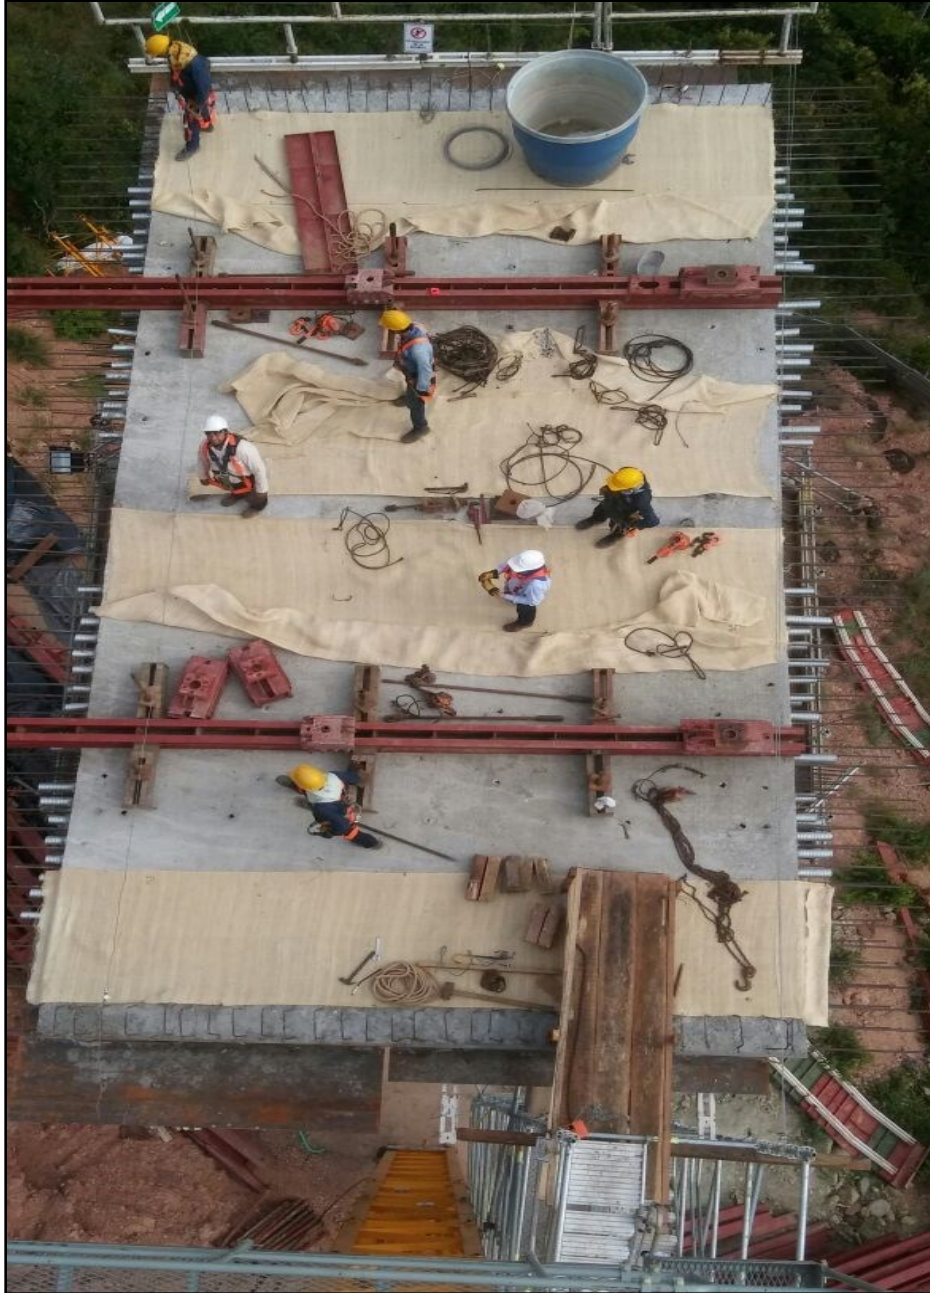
Instalación fique losa superior dovela Eje 2. Fuente: Constructora Colpatria
